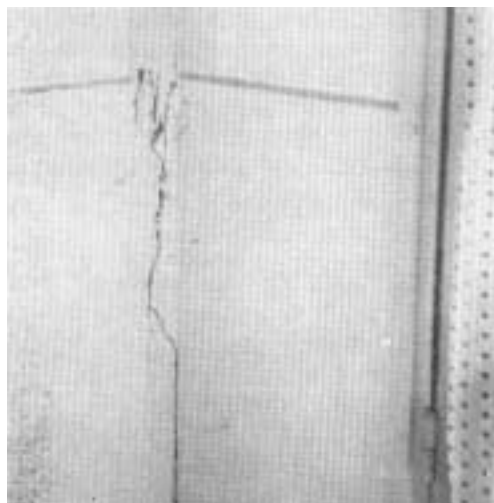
Fundações sobre aterro : apareceram fissuras após a construção de um pavilhão vizinho
